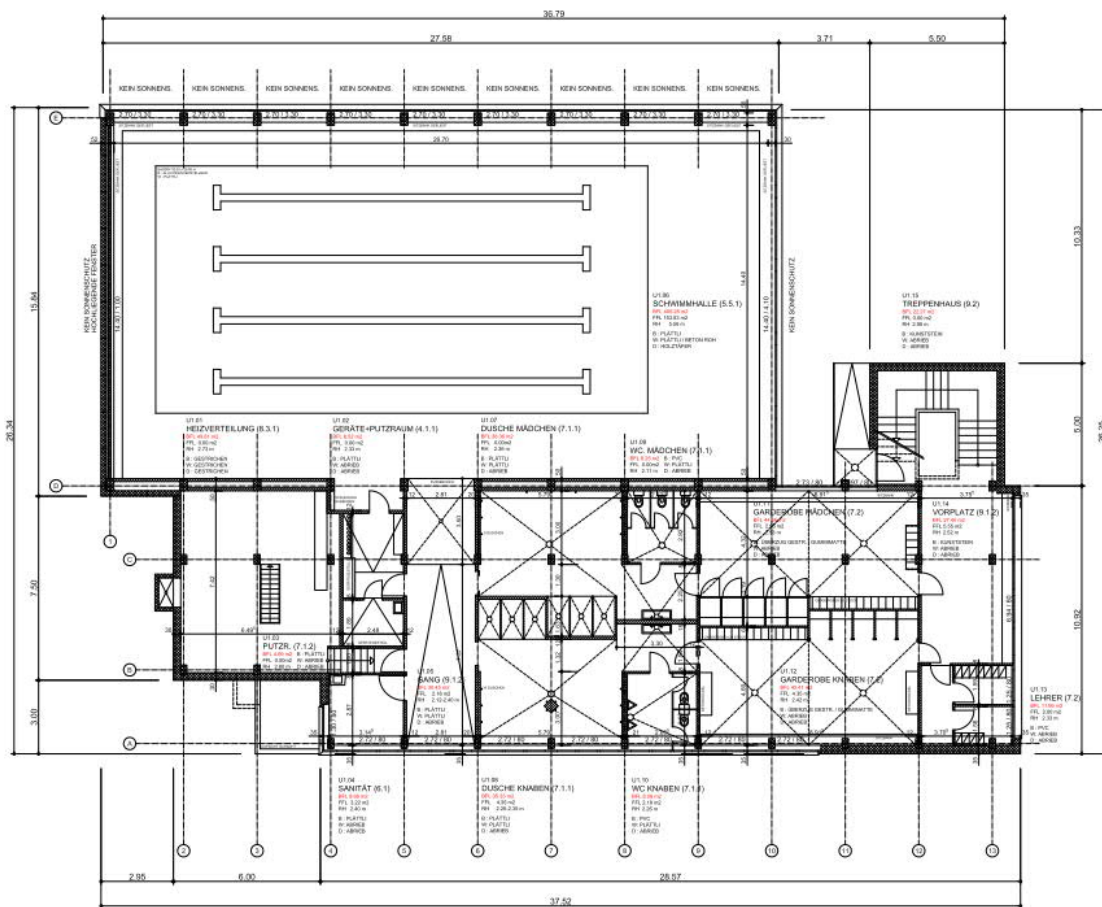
Grundriss UG mit Schwimmhalle und Garderoben.
